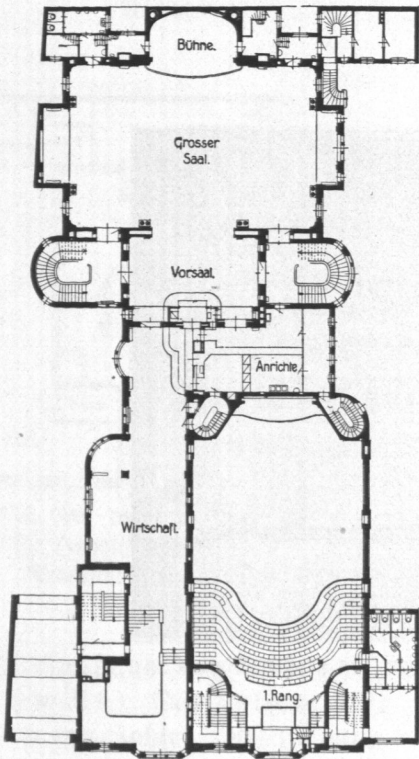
Bürgerfäle Eilbeck, erstes Obergeschoß, Grundriß.
